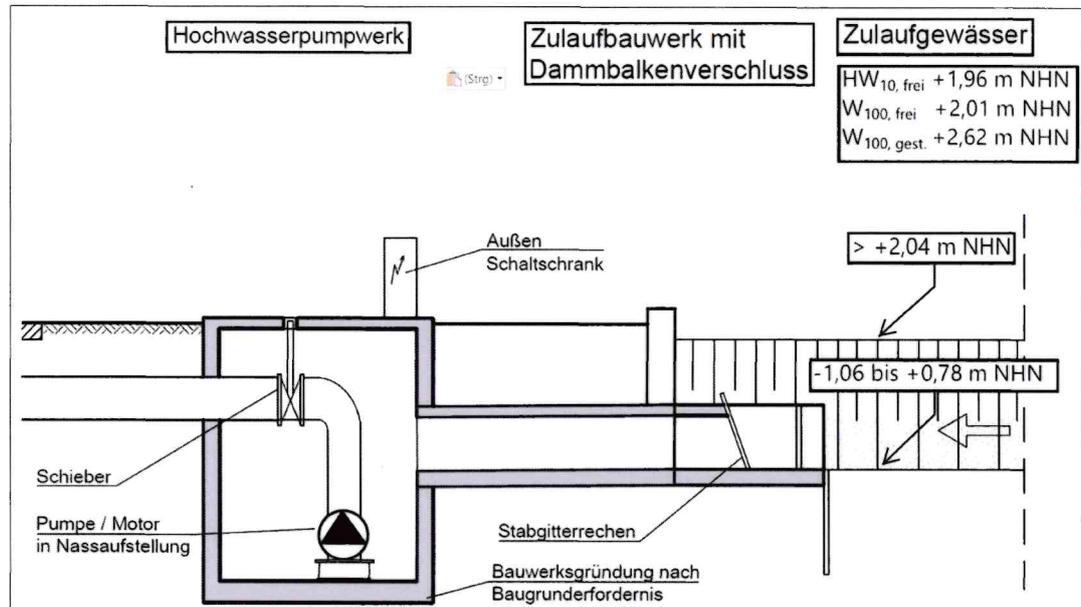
Schema Hochwasserpumpwerk mit Anschluss an Sielzulauf
